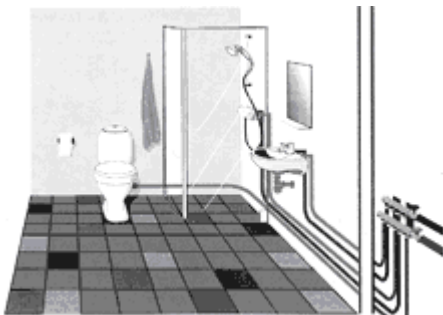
Открытая прокладка пластмассовых труб холодного и горячего водопровода в санузле - коллекторный вариант
